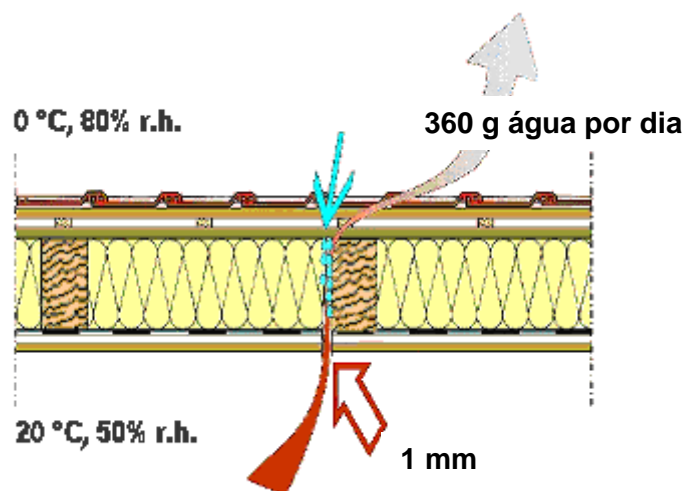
Condensação devido a fissuras (Fonte: Adaptado de *Passive House Institute*, 2014)
